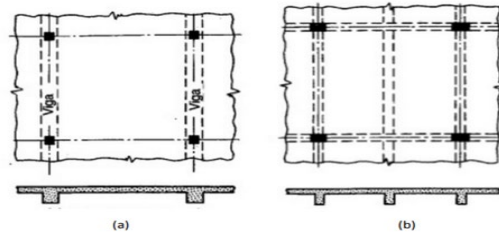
Losas en una dirección (a) Sin Vigas interiores. (b) Con Vigas interiores
